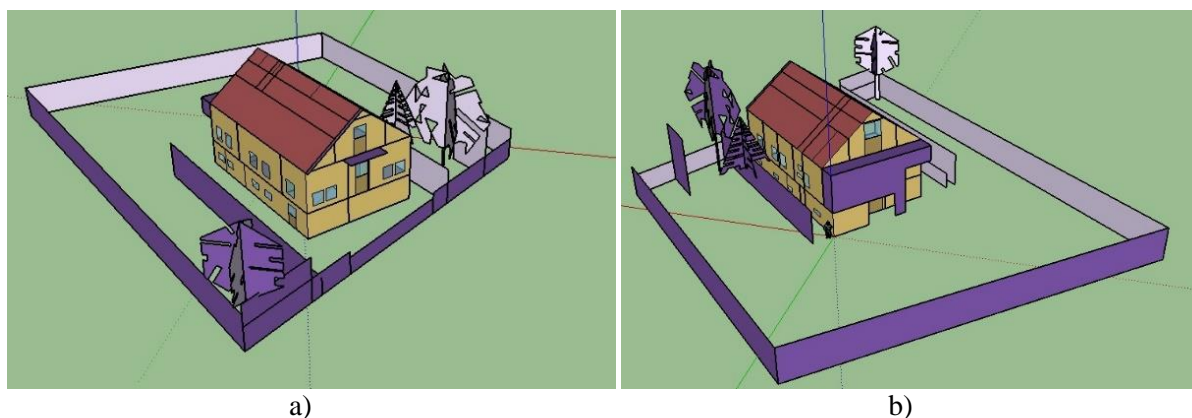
Geometria exterior do modelo. a) Fachadas orientadas a SE e SW; b) Fachadas orientadas a NW e NE.
